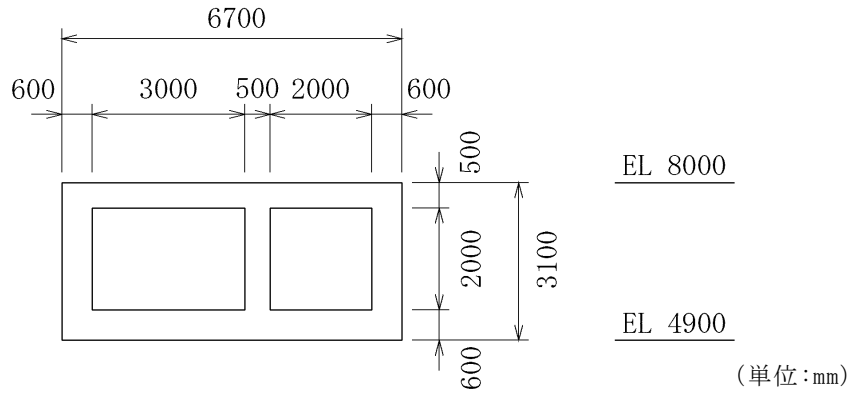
屋外配管ダクト (タービン建物～排気筒) 断面図 (A-A 断面)
